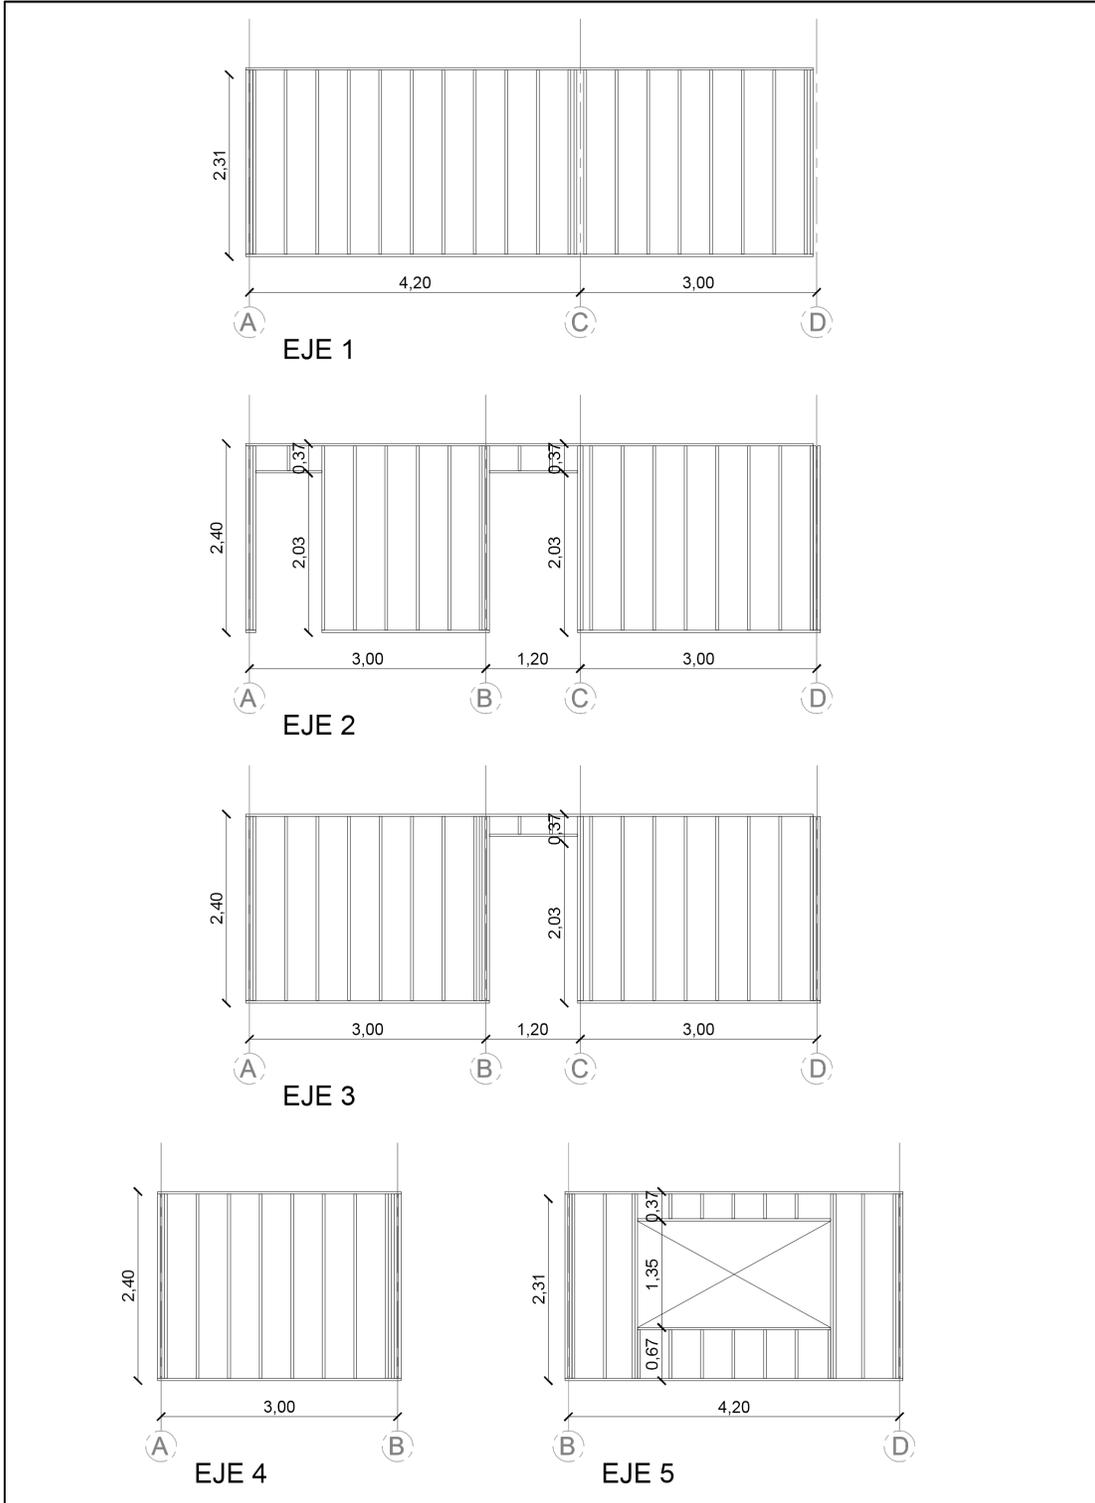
Elevaciones de estructuras modelo acero galvanizado
